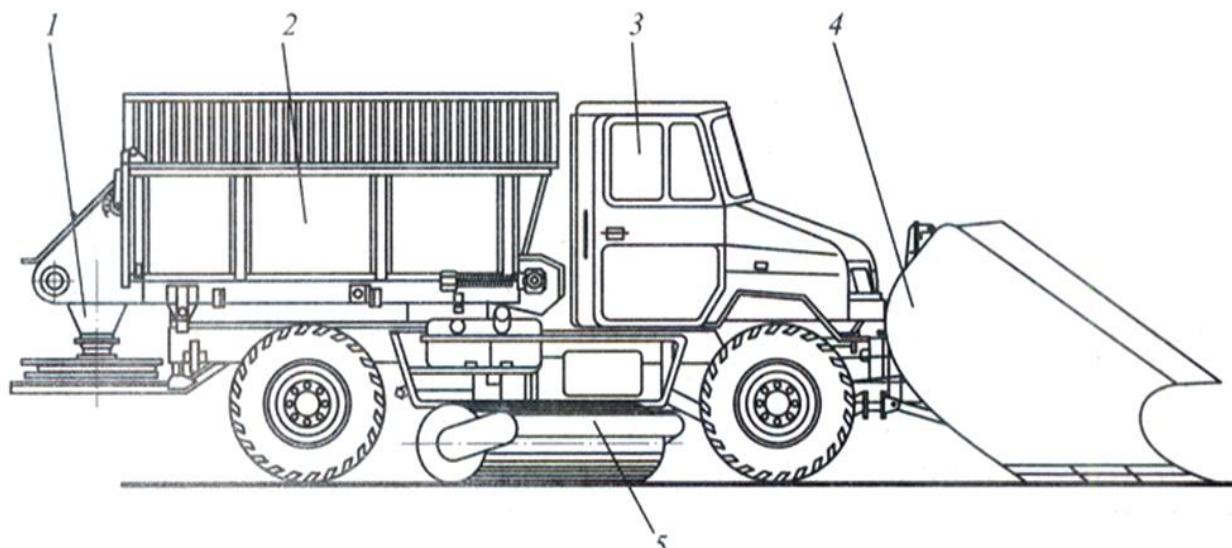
Снегоочиститель плужный, с подметальным оборудованием и пескоразбрасывателем
